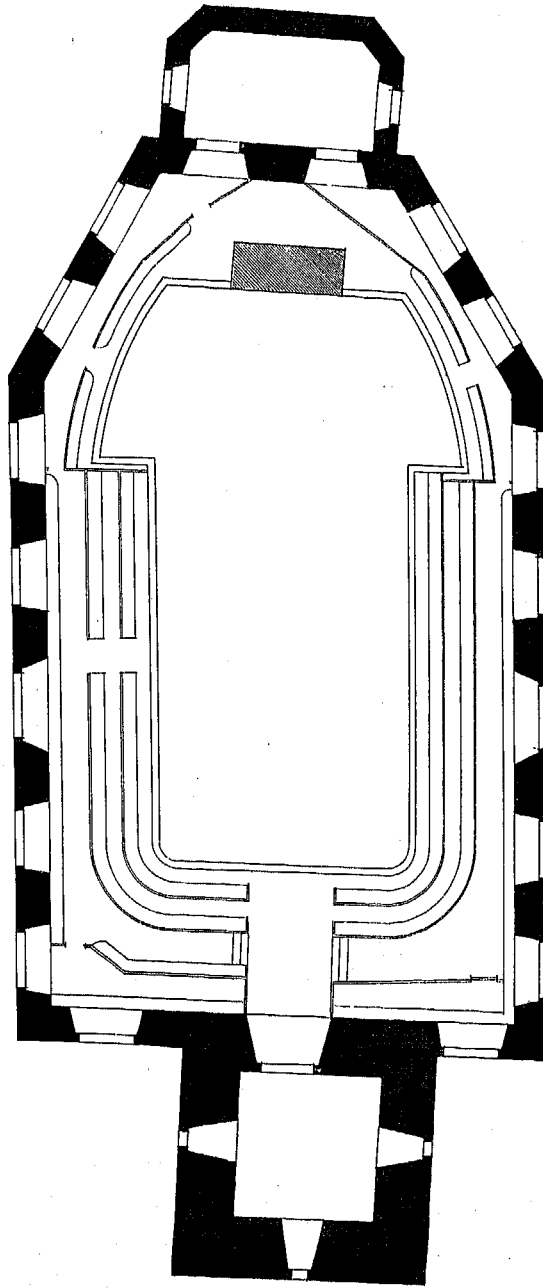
Grundriss der Emporen (frühere Anordnung.)
